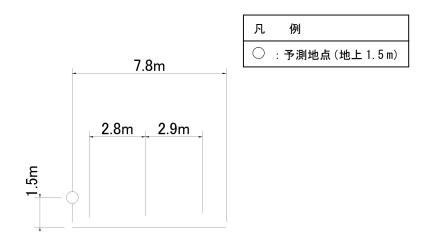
(2)予測断面図(B.一般県道栗林宮田停車場線沿道(宮田村 5610-1 地先))
